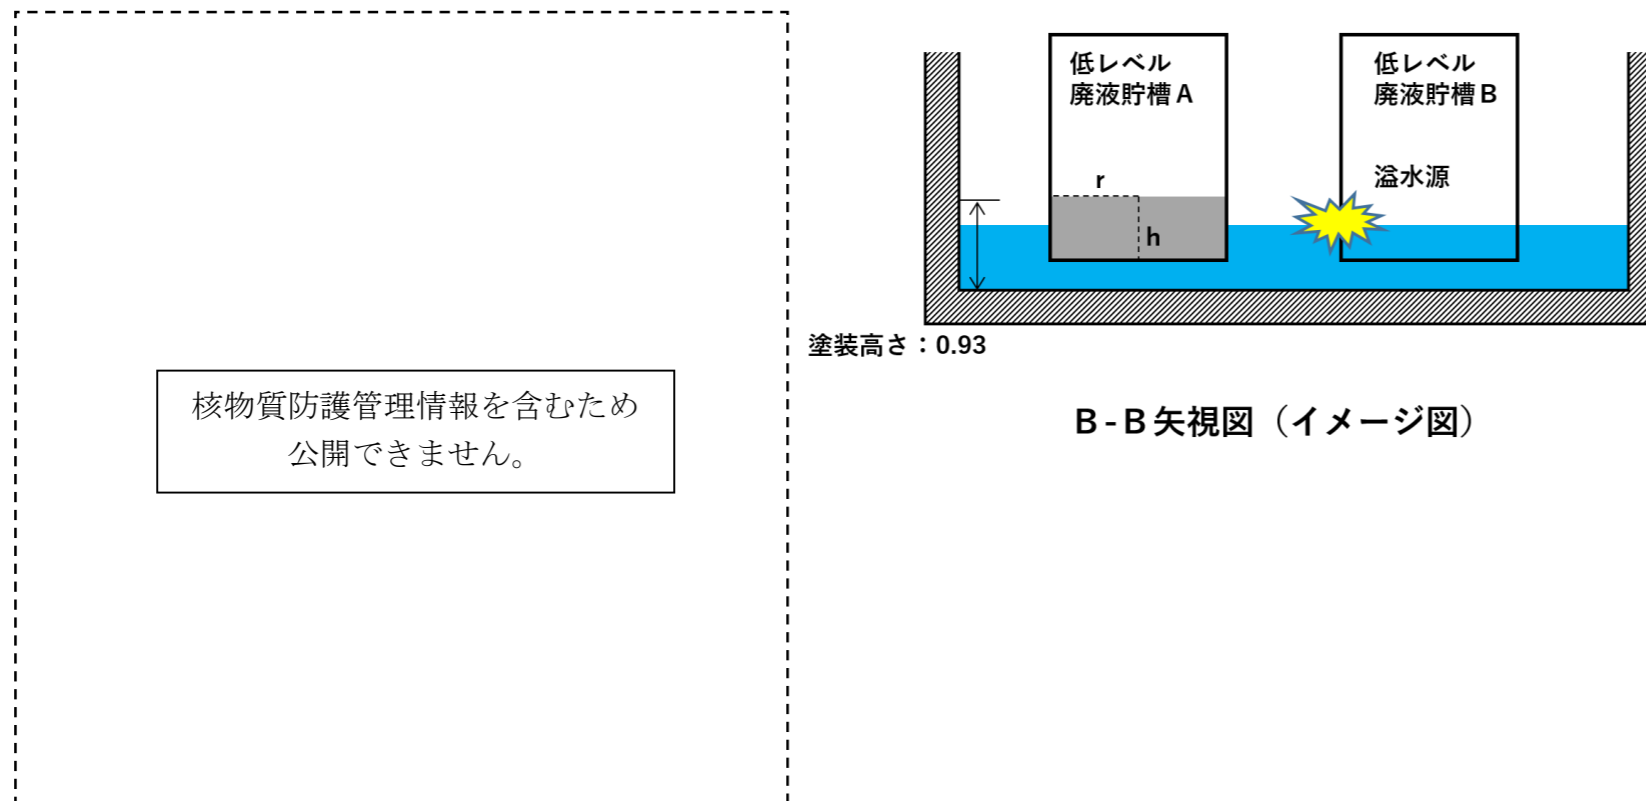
2. 1-1 廃液貯槽室（Ⅶ）の配置図（実験棟B地下1階平面図）
